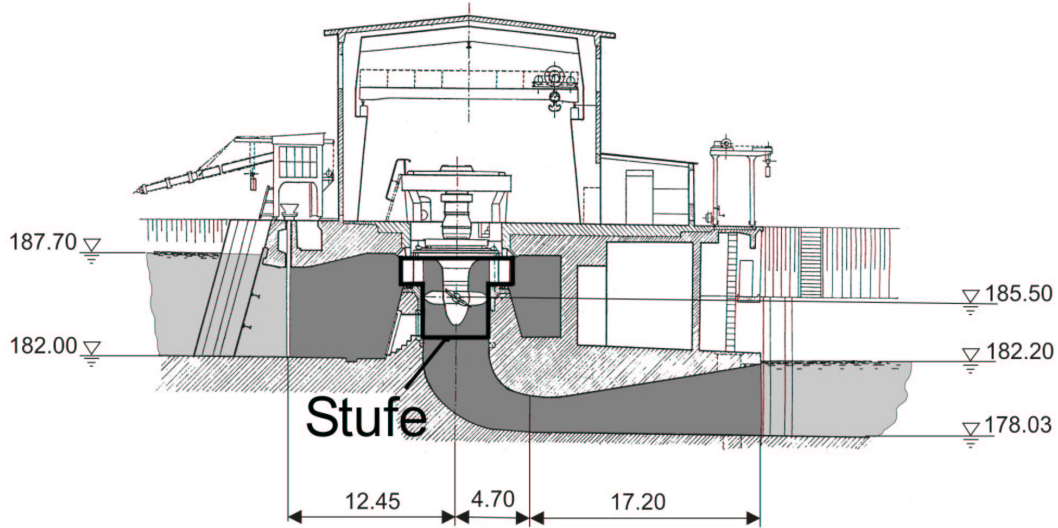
Seitenansicht des Kraftwerks „Dettelbach“
